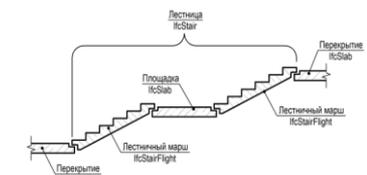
Пример моделирования сборных железобетонных лестниц
